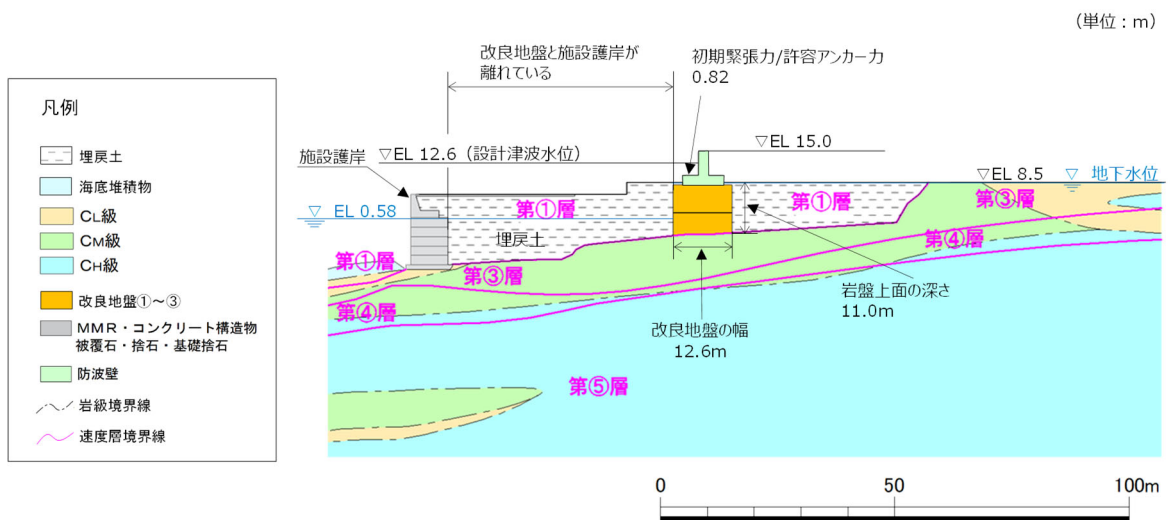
防波壁（逆 T 擁壁）の横断面図（⑥-⑥断面）
